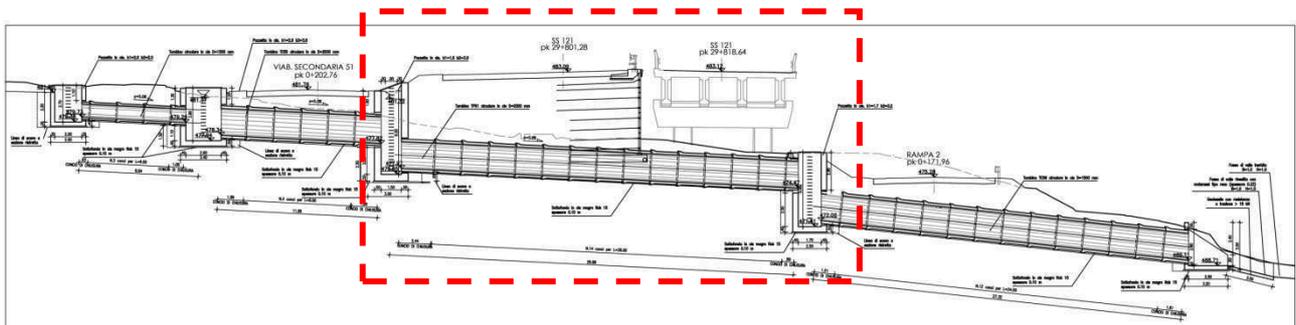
Sezione longitudinale TP61, Progetto PEA, con indicazione del tratto interessato da modifiche
